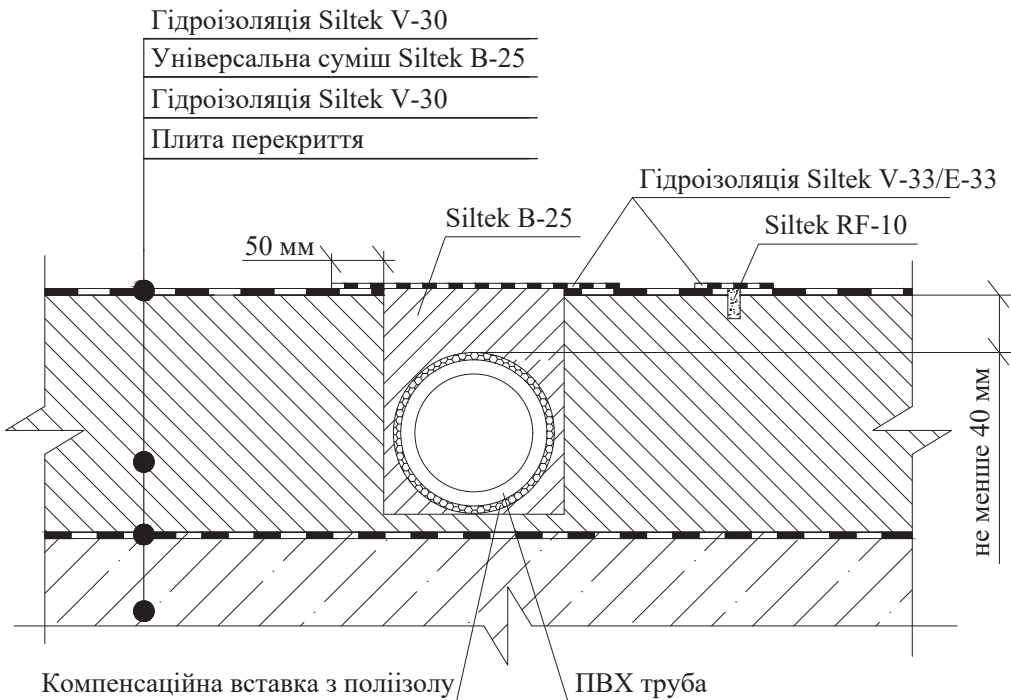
Схема ремонту стяжки над ПВХ трубою з влаштуванням гідроізоляції
